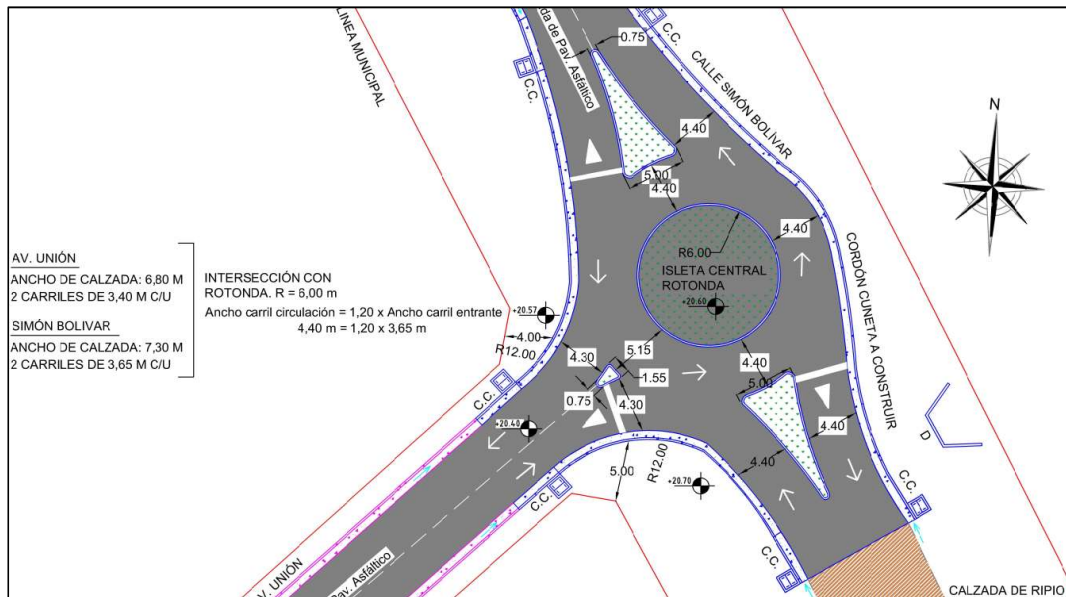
Rotonda Proyectoada Av. Unión y Calle Simón Bolívar.
